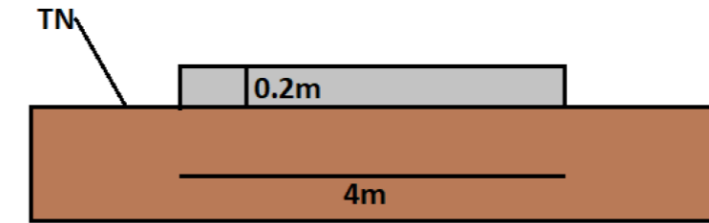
Coupe type voirie piste légère (Source : Photosol)
